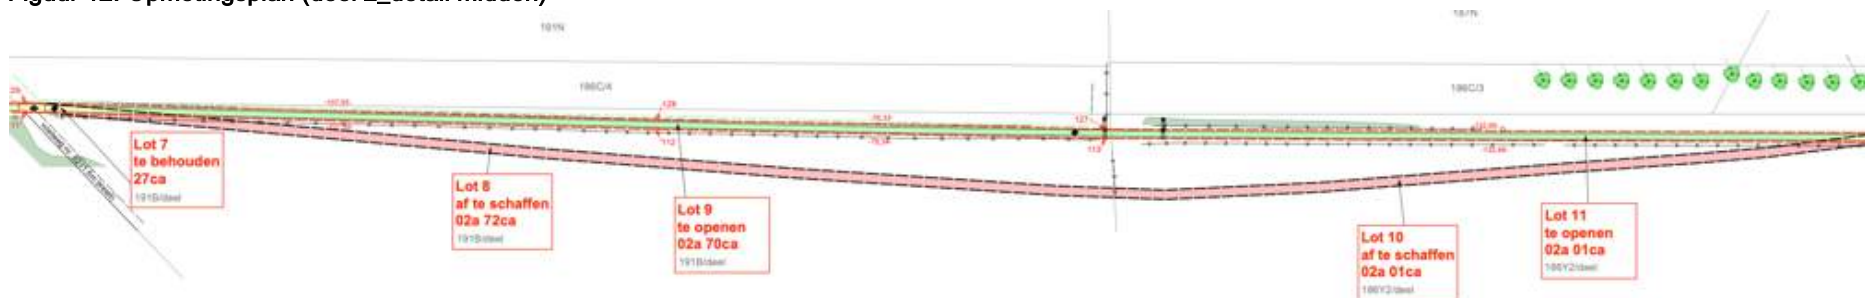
Opmetingsplan (deel 2_detail zuid)
